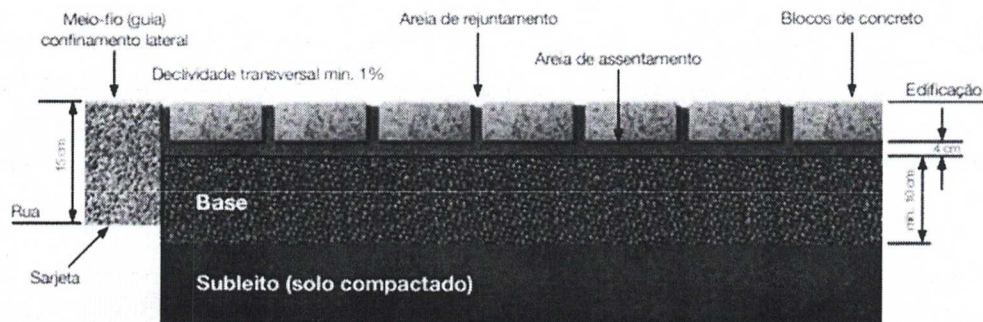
Perfil do pavimento mostrando subleito, a base e o pavimento.
